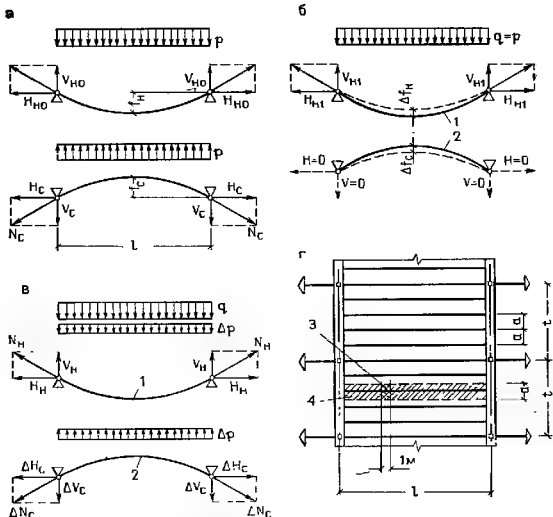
Расчетные схемы параллельно расположенных вант в двухъярусном покрытии: а — стадия предварительного напряжения; б — стадия погашения внешней нагрузкой предварительного напряжения покрытия; в — расчетная схема вант в стадии эксплуатации; г — план покрытия; 1 — несущая ванта; 2 — стабилизирующая ванта; 3 — площадка действия линейных нагрузок q , p , Δp ; 4 — грузовая площадь на вантовую ферму
